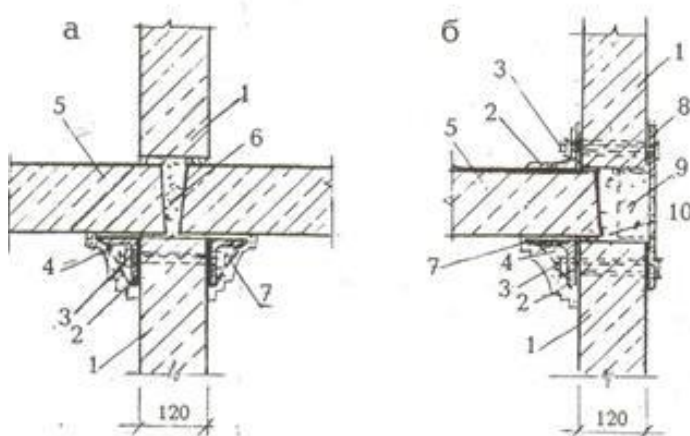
Усиление узлов сопряжения панелей стен с панелями перекрытий
